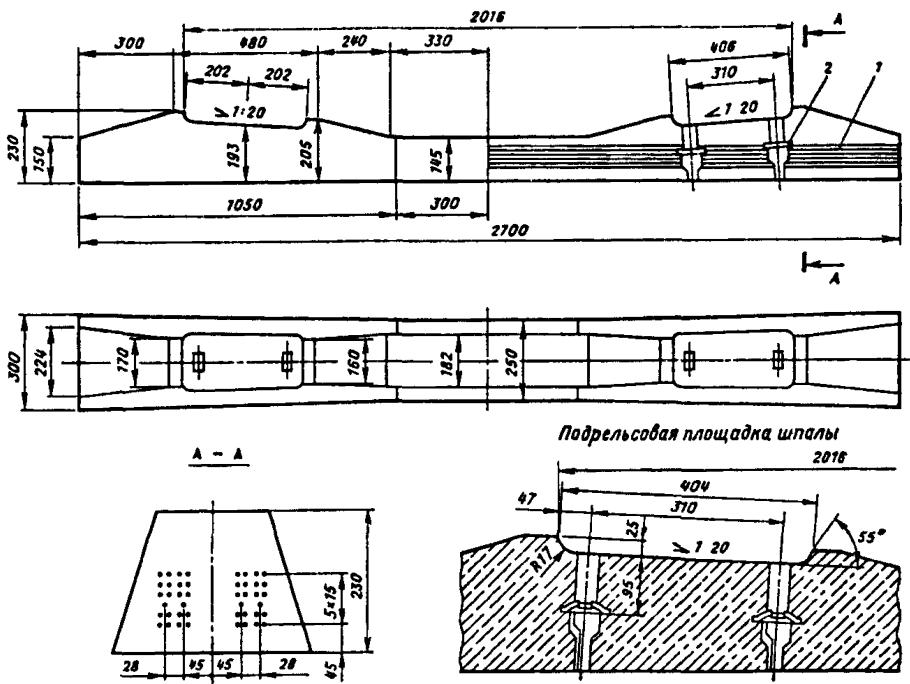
Железобетонная шпала типа Ш1-1:
